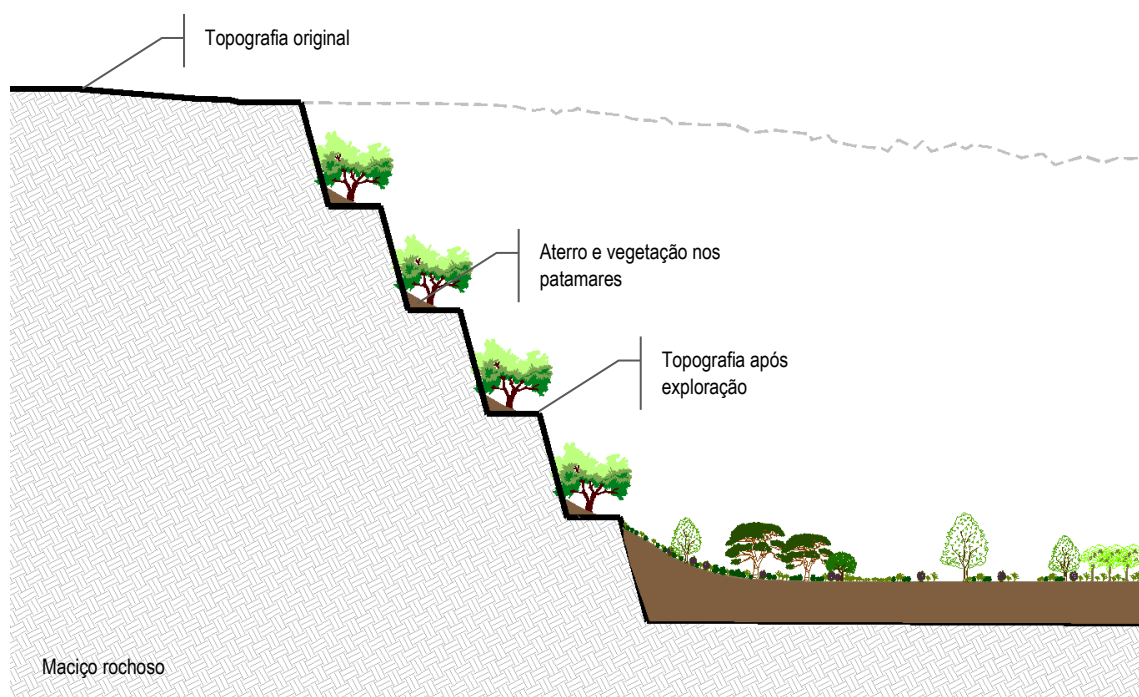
Perfil esquemático da recuperação paisagística nas cortas com solução de aterro nos patamares de escavação.
